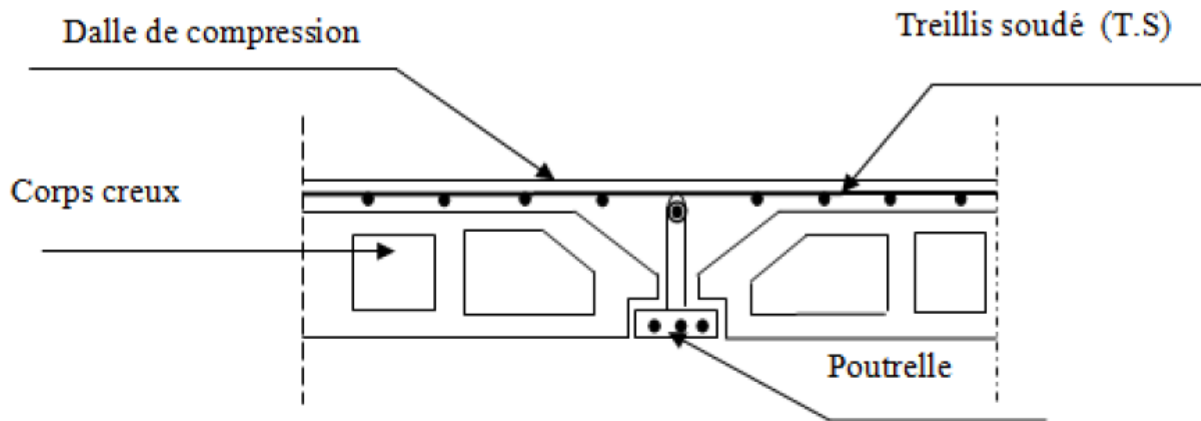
Coupe transversale dans un plancher en corps creux
